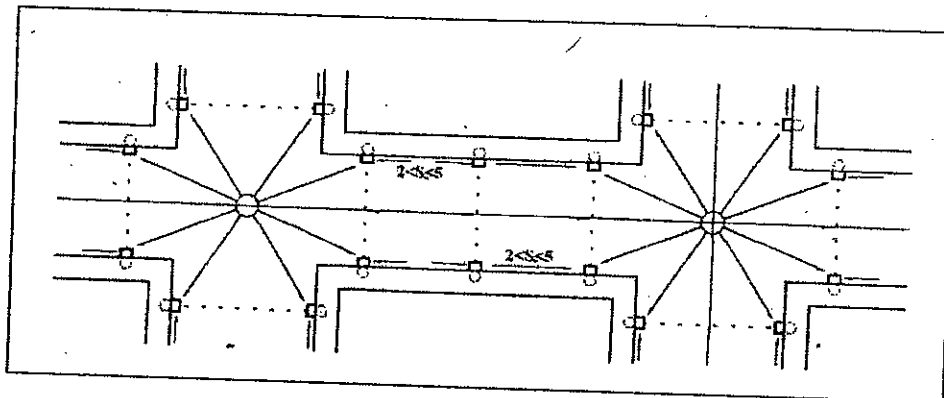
Ubicación de Coladeras de Piso y Banqueta.
